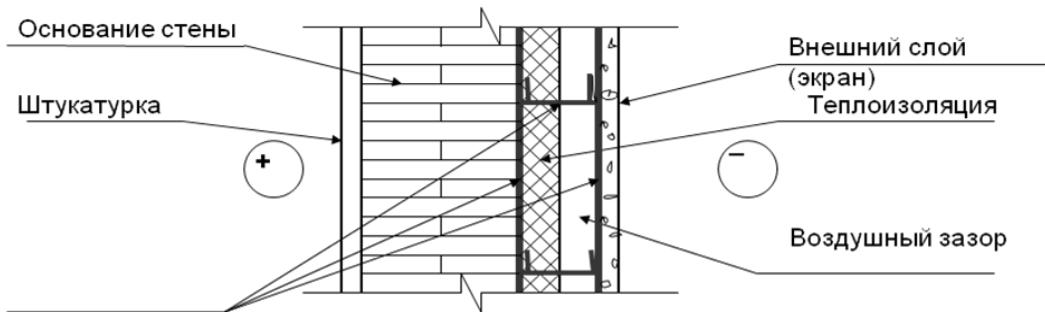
Конструкция фасадной системы с вентилируемым воздушным зазором
